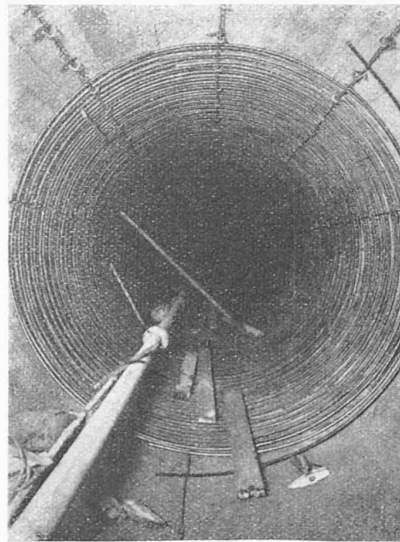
Montierung der einfachen Armierung für den Gunitmantel.
